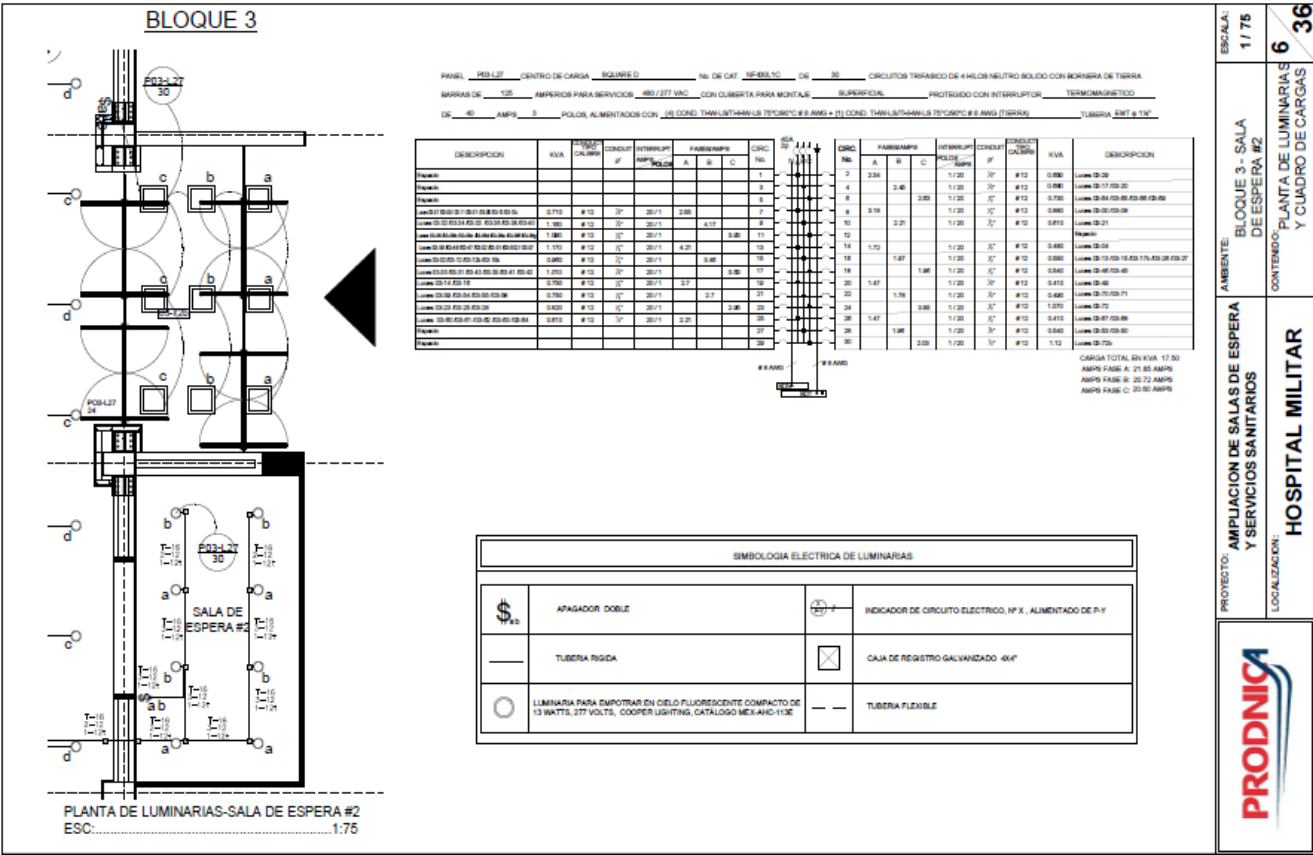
Lamina de plantas arquitectónicas de luminarias
